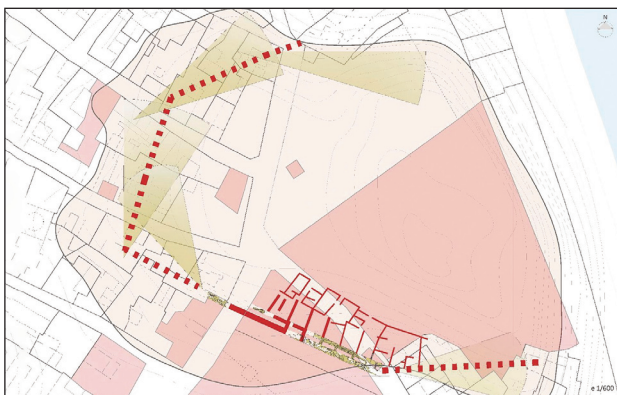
Planimetría con la propuesta del trazado de la muralla.
